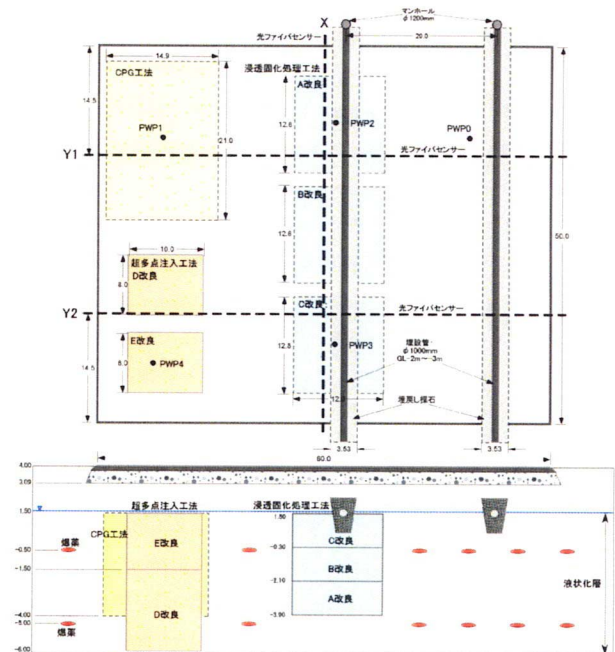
アスファルト舗装部分における平面図および断面図 (単位: m)
